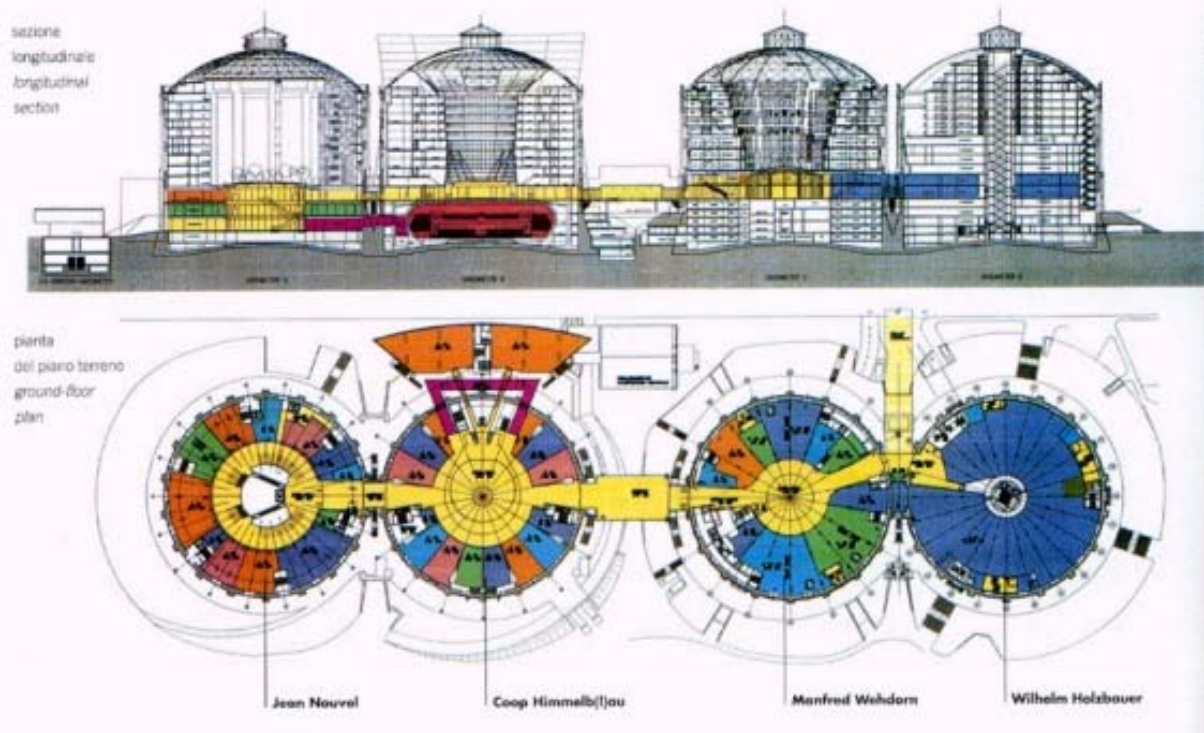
Planimetria e sezione dei 4 gasometri, 1998
